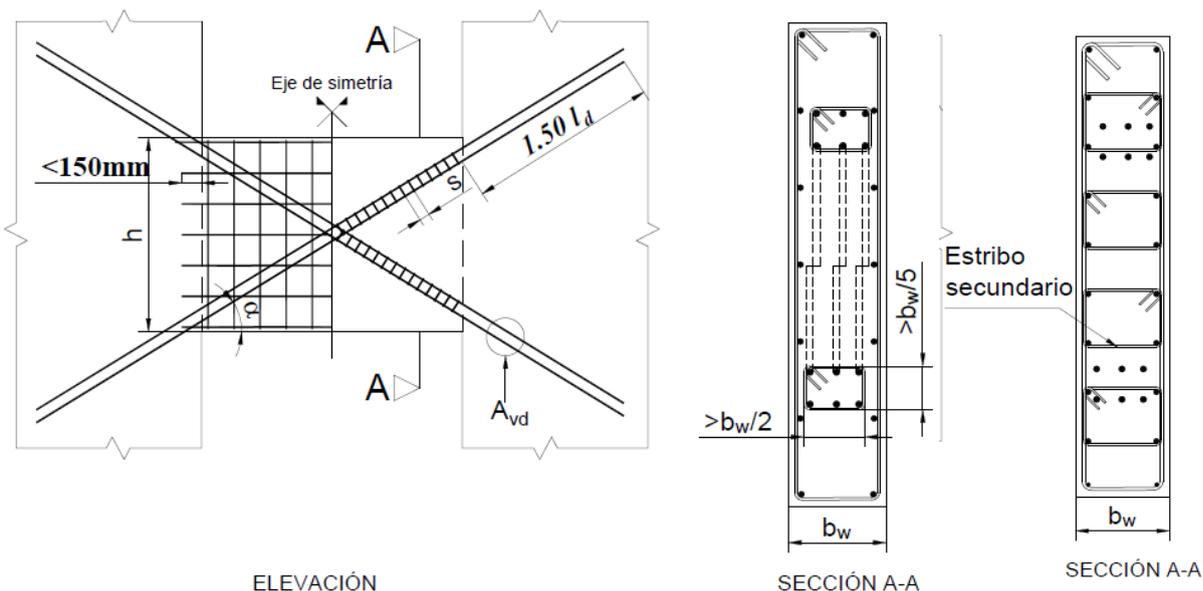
Confinamiento de armadura diagonal y de la sección completa de hormigón.
